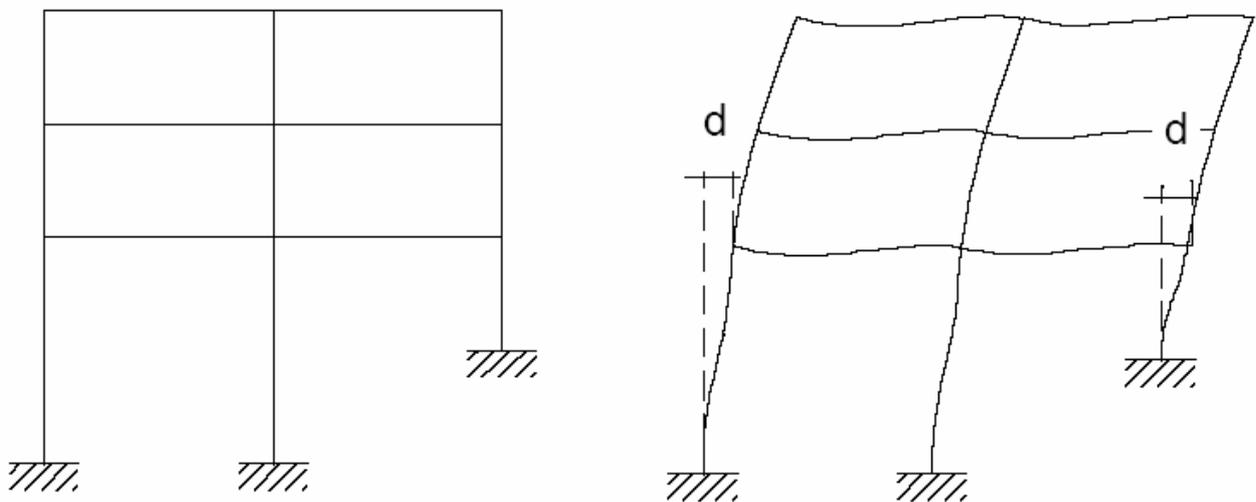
Efeitos de pé-direito duplo e fundação elevada, por motivo da geometria (comprimento) dos elementos [14]
